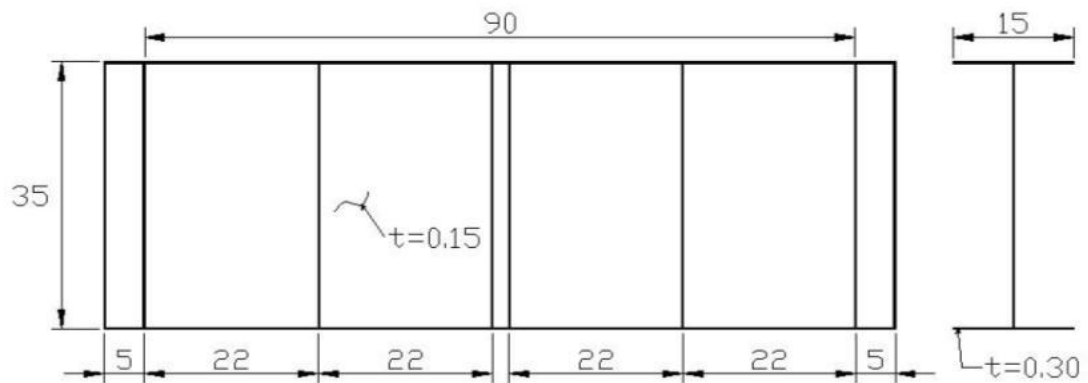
Plano en centímetros de la segunda configuración de viga I
